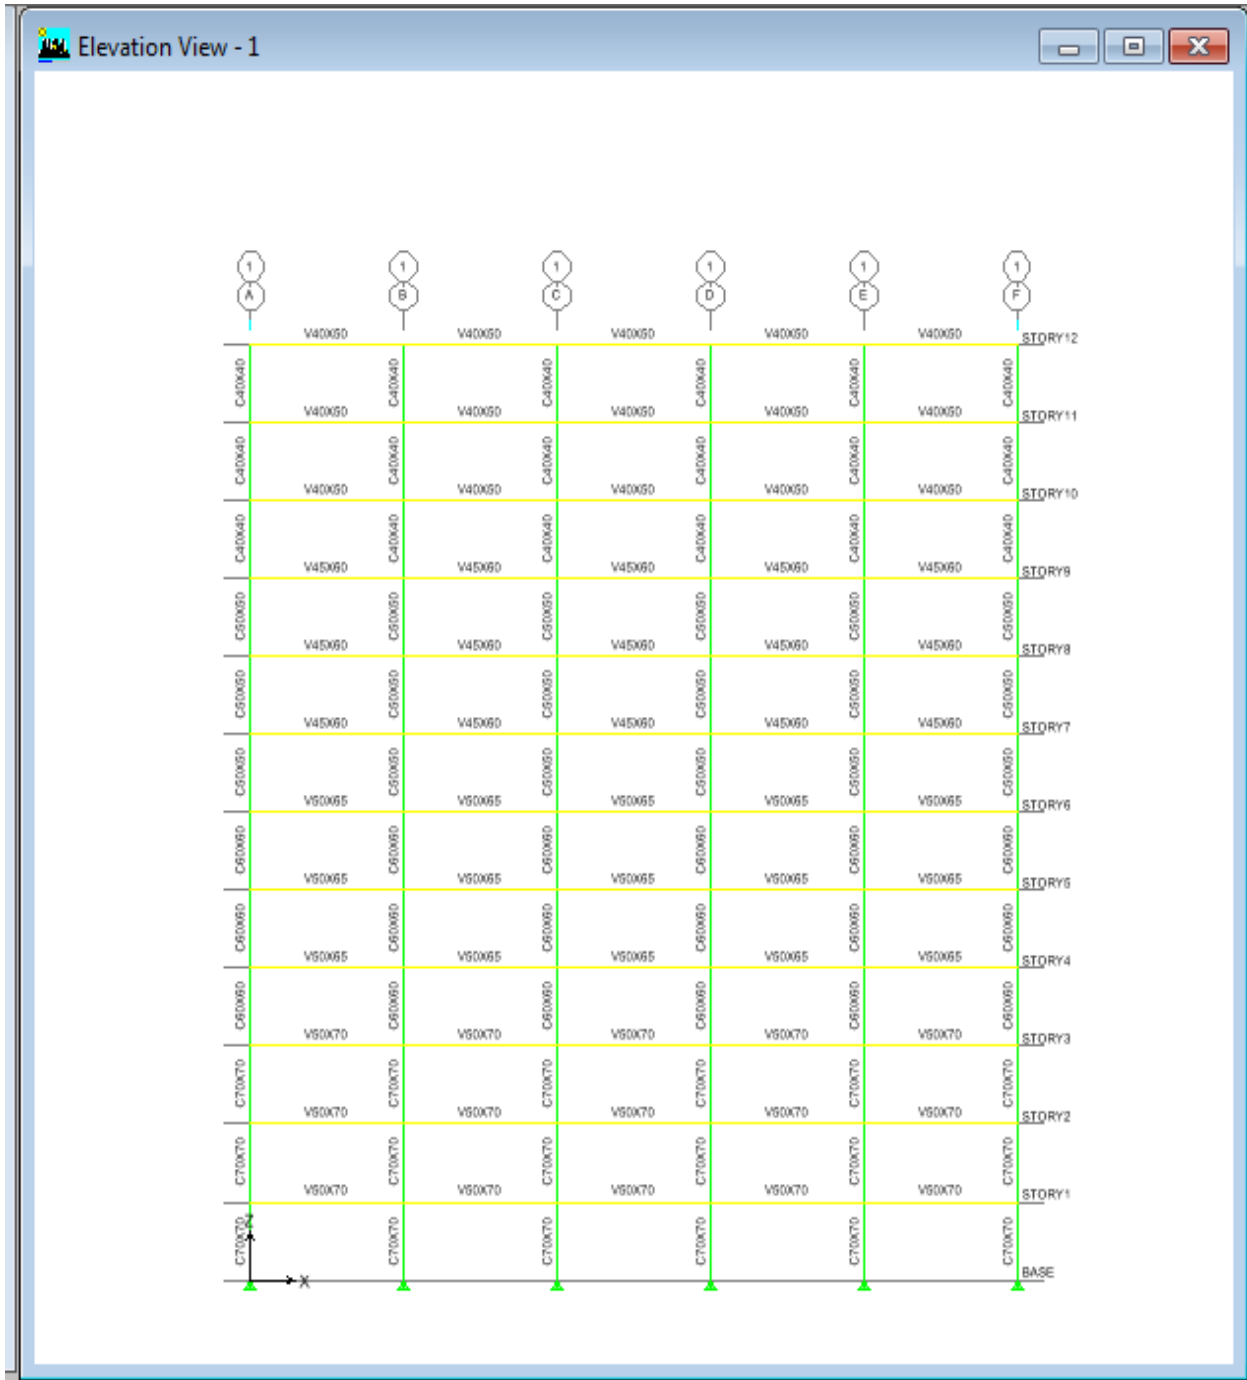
7 Vigas y Columnas asignadas al pórtico para el análisis en el plano
